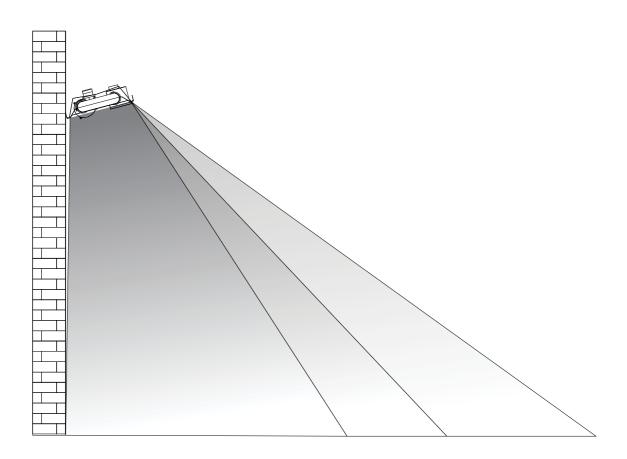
Монтаж на стене с помощью кронштейна типа "макси" (высота установки – не более 7 м).
